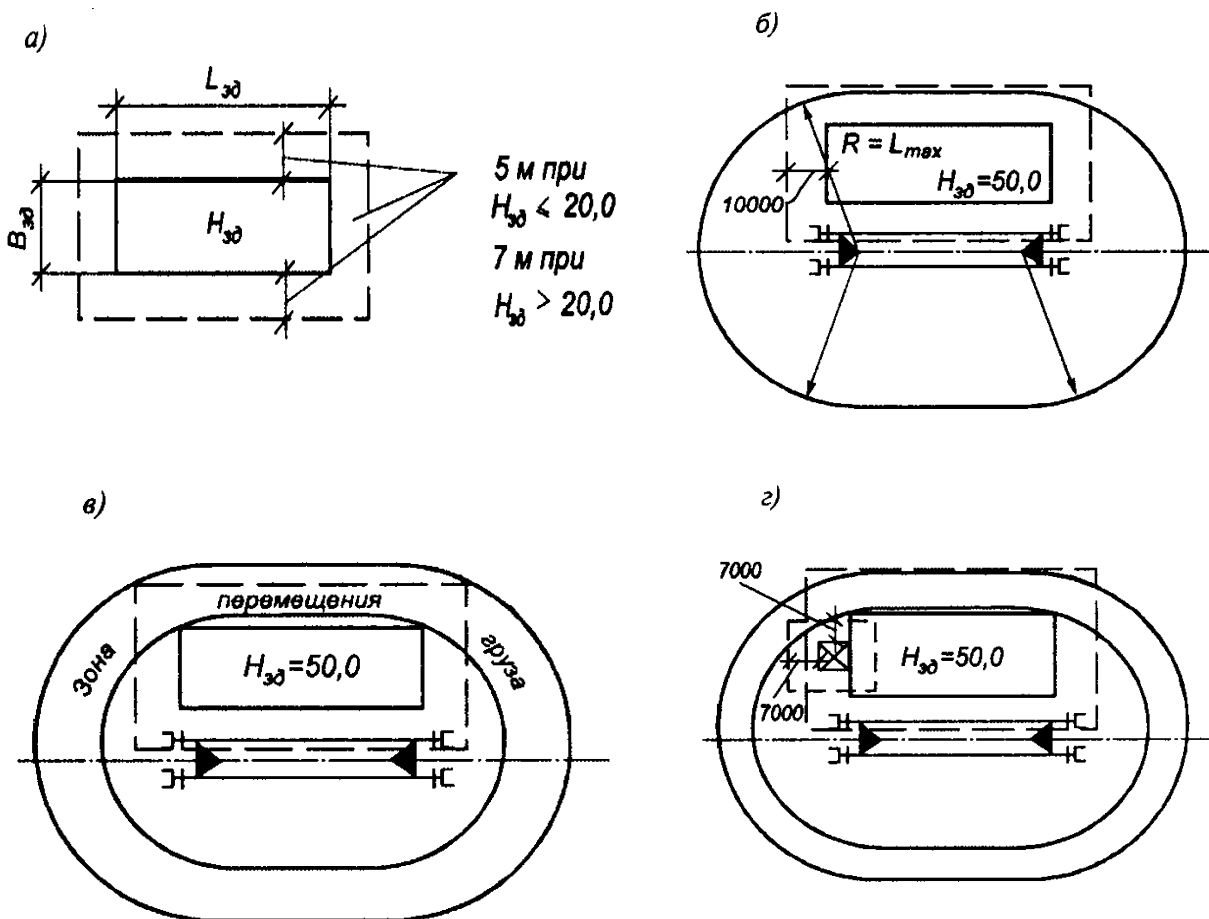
Определение необходимых зон при возведении надземной части зданий башенным или рельсовым стреловым краном: а - монтажной зоны; б - зоны обслуживания башенного крана; в - зоны перемещения груза; г - зоны работы подъемника
